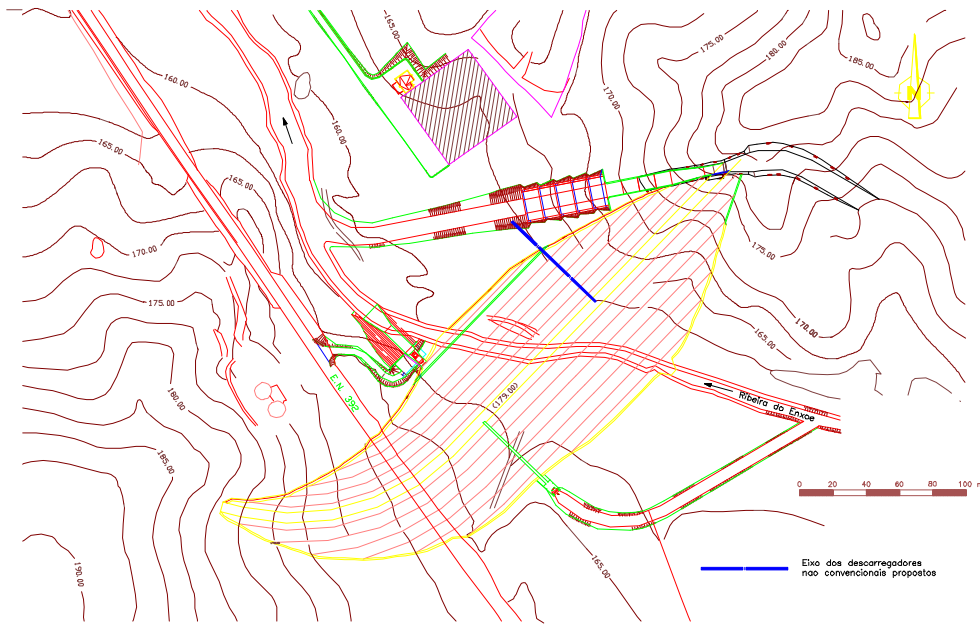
Barragem do Enxoé. Planta (adaptado de HP, 1994).
